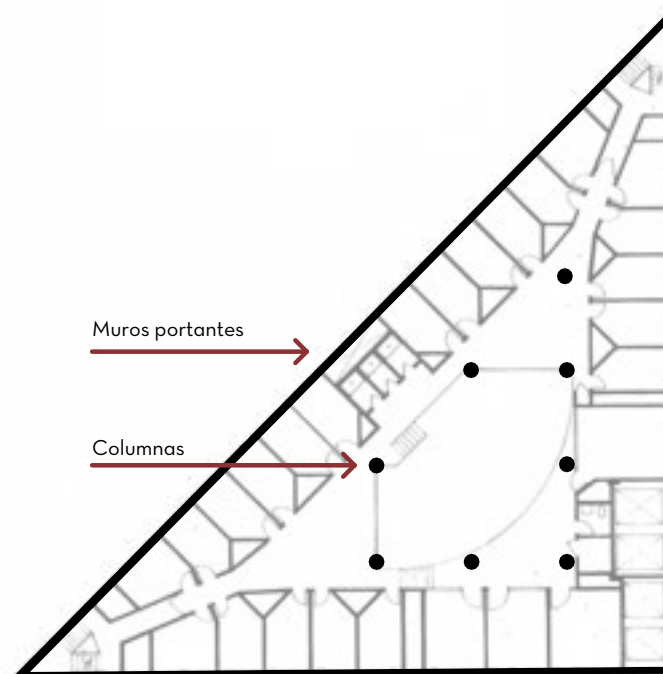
Planta del centro. Fuente: Jhonatan Chloe
